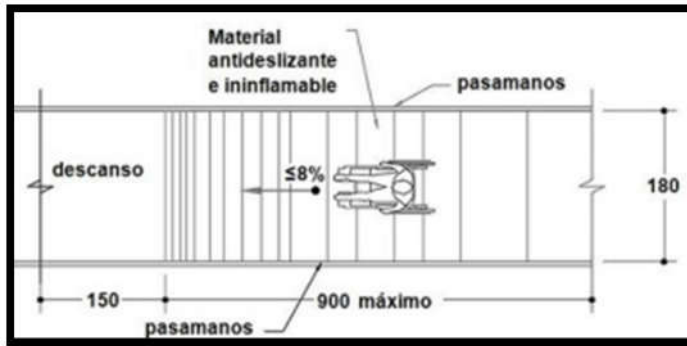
Detalle de rampa/ Fuente Normativa Técnica de Accesibilidad
